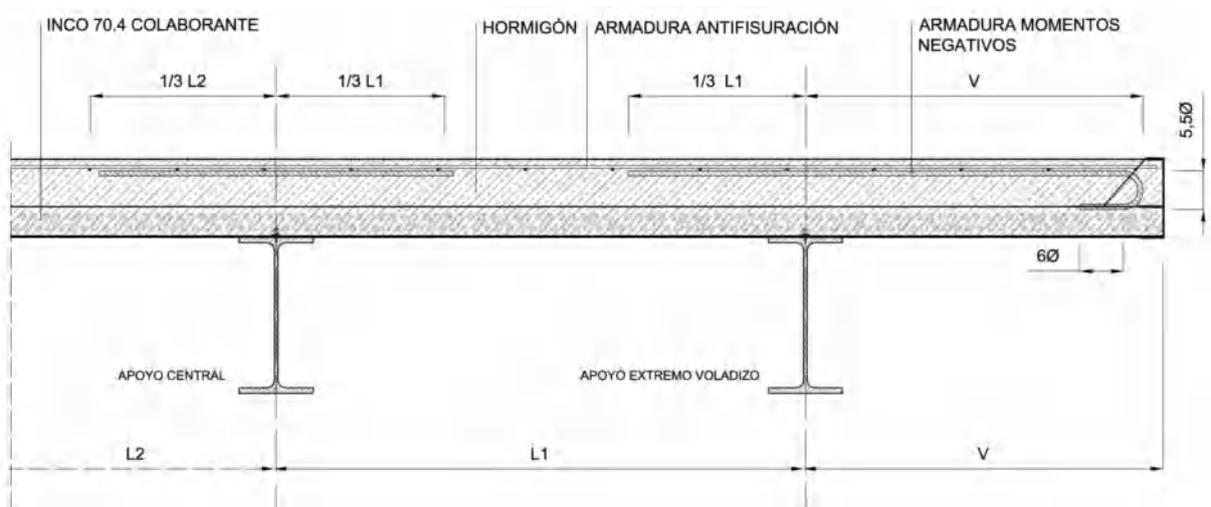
"Disposición de las armaduras de negativos sobre apoyos intermedios y voladizo"
